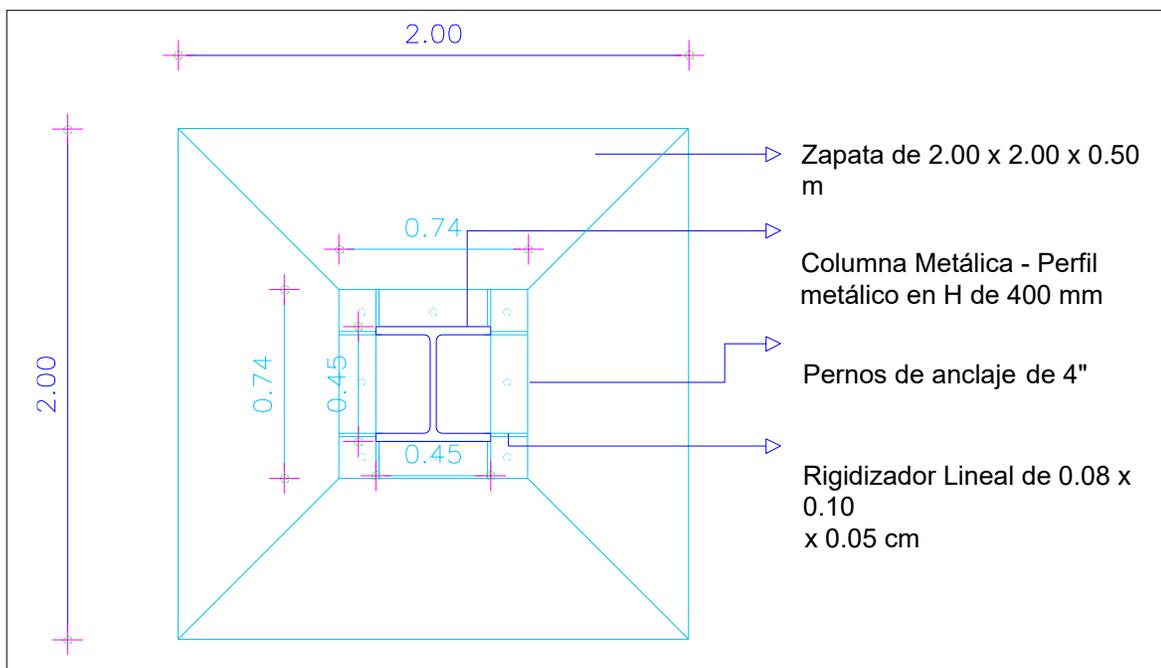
Detalle zapata aislada, Fuente: elaboración propia.
